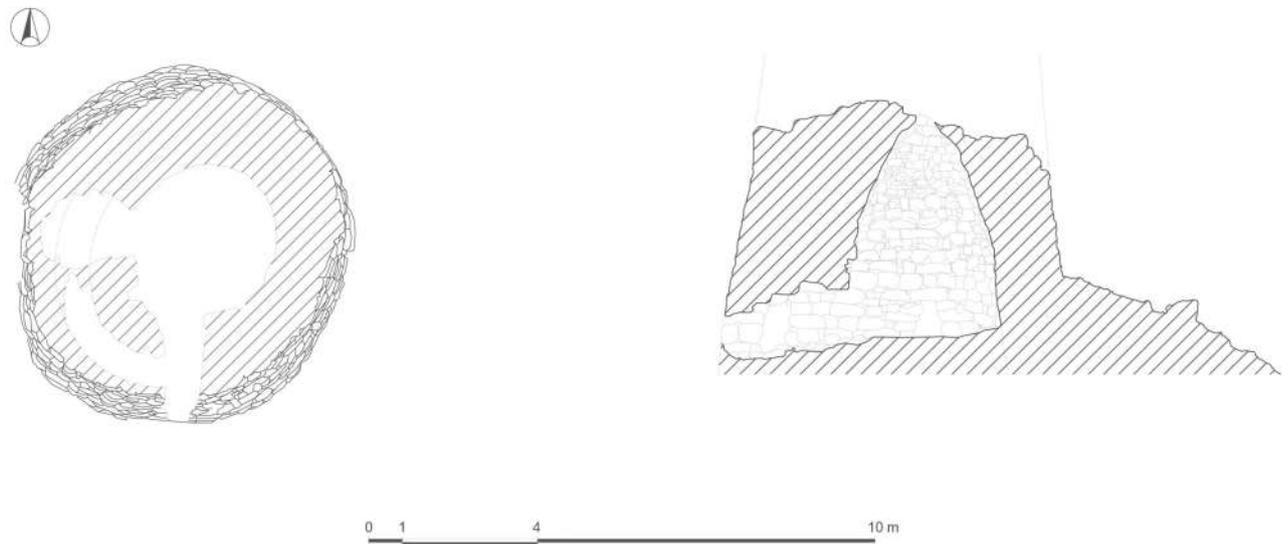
ULASSAI – Nuraghe S'Ulimu. Planimetria e sezione della torre principale (rilievo A. Mossa)
